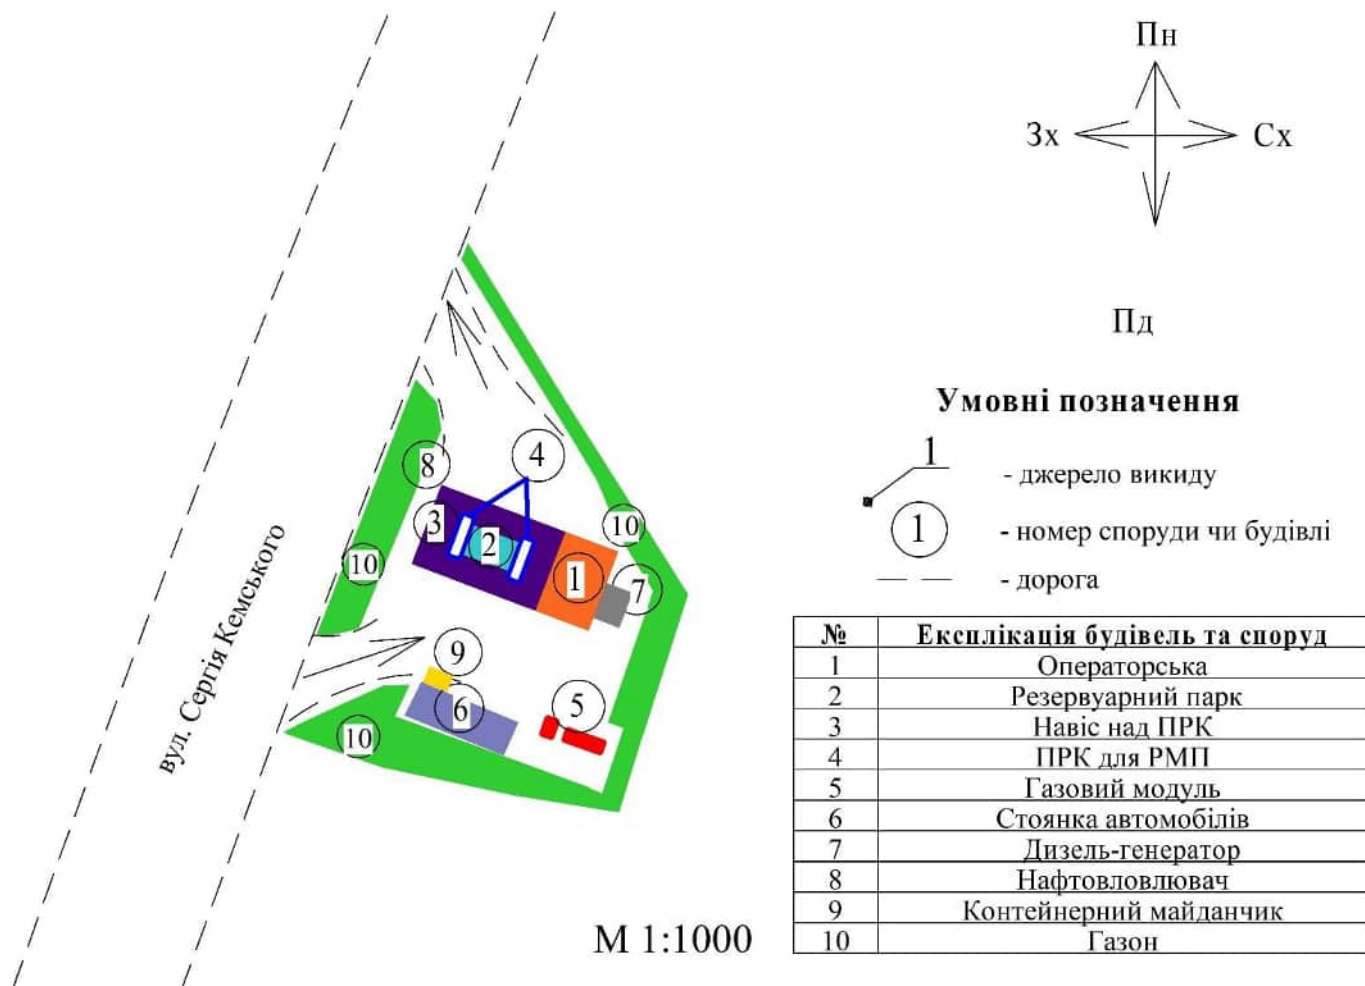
Розташування будівель та споруд на території БП АЗК
